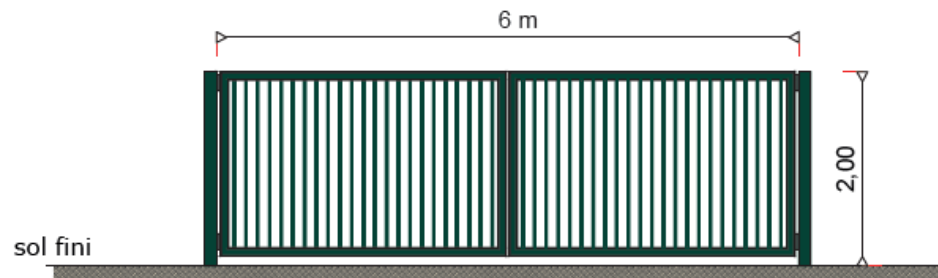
DETAILS - ÉLÉVATIONS DU PORTAIL D'ENTRÉE ET DE LA CLÔTURE - échelle 1/40e
